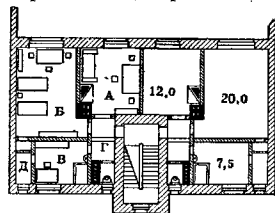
План средней секции блочного 2-этажного кирпичного дома. Две квартиры в этаже по 2 комнаты с жилой площадью в 32 м² (тип Укр. техн. стр. к-та). А и Б—жилые комнаты; В—кухня; Г—передняя; Д—кладовая.
